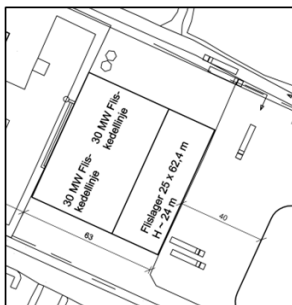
Flislager øst for det planlagte biomasseværk.
